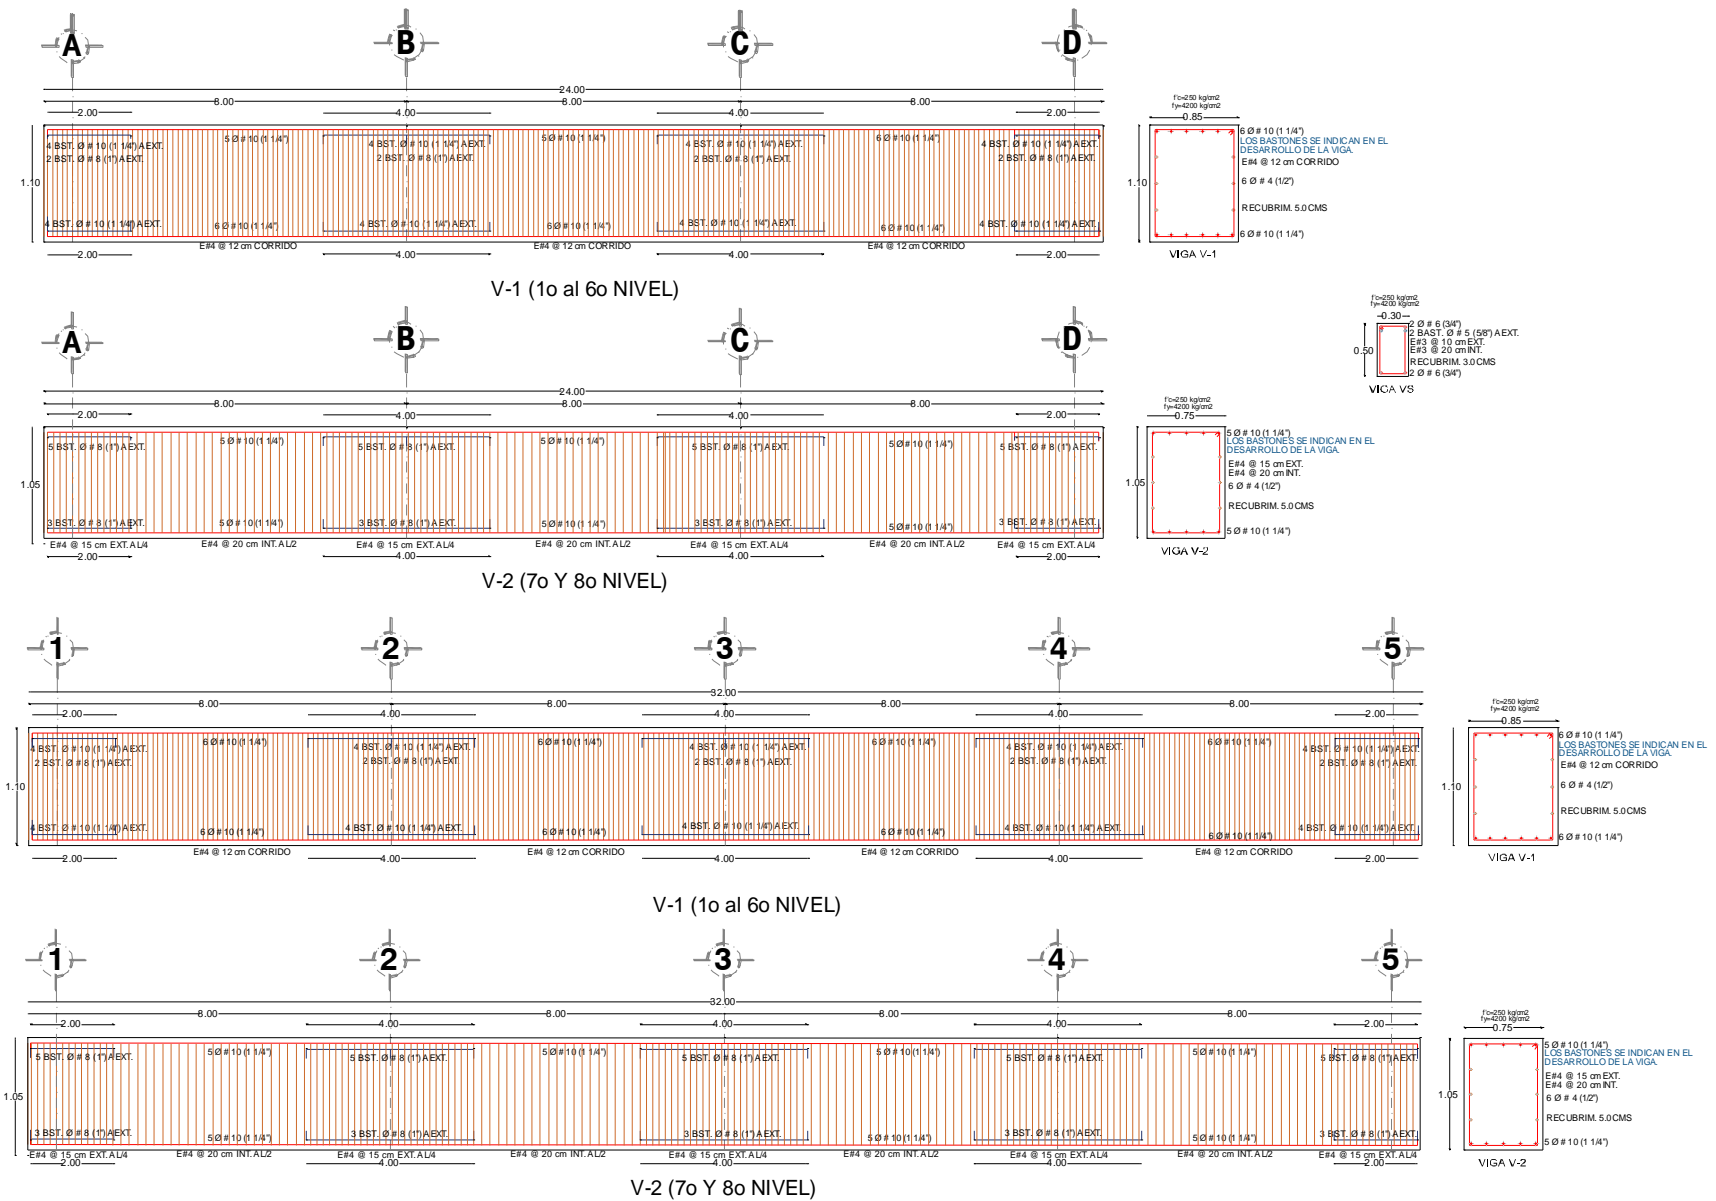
Detallado de armado de vigas de edificio de 12 niveles con base a la hipótesis de las NTCC-17.
